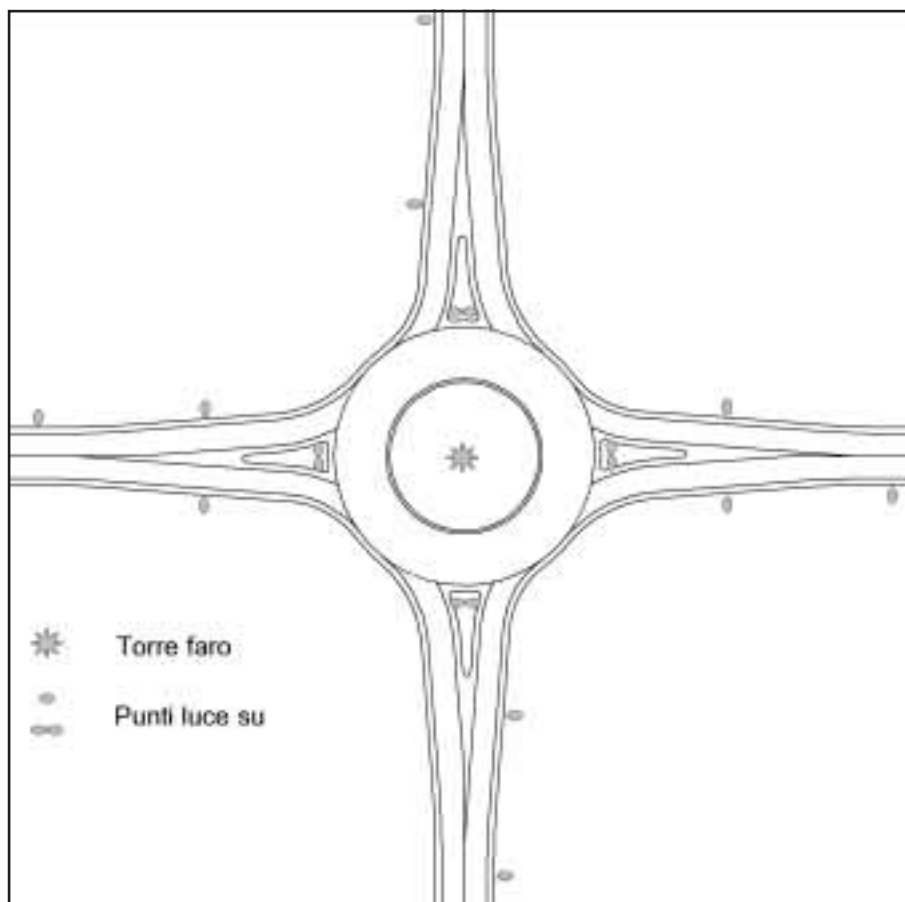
Rotatoria illuminata con disposizione centrale
